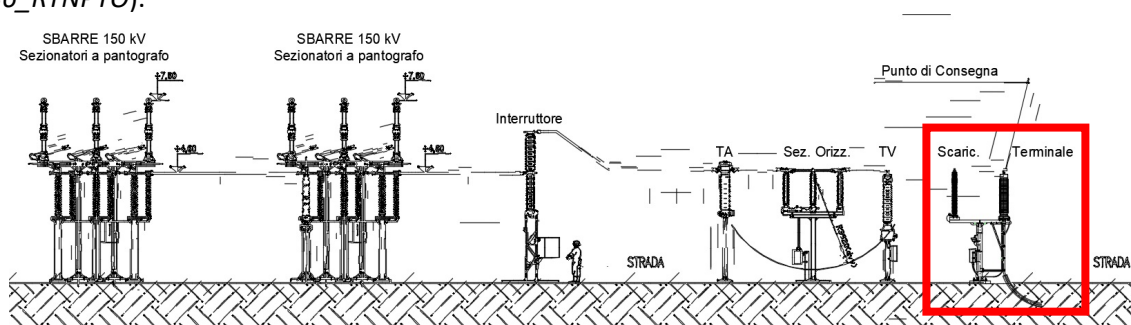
sezione stallo RTN assegnato – in rosso sono perimetrare le opere di nuova installazione
